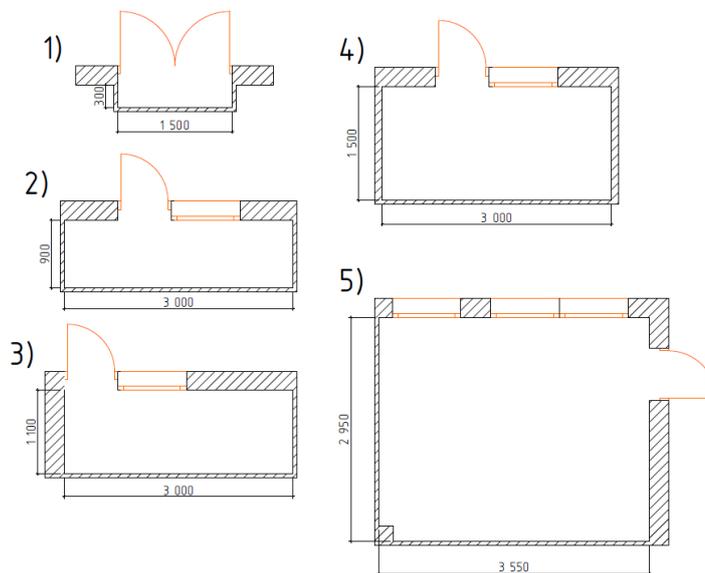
Исходные данные для планировочной организации открытых пространств квартиры: 1 – французский балкон; 2 – открытый консольный балкон; 3 – угловой балкон; 4 – лоджия; 5 – крытая терраса
